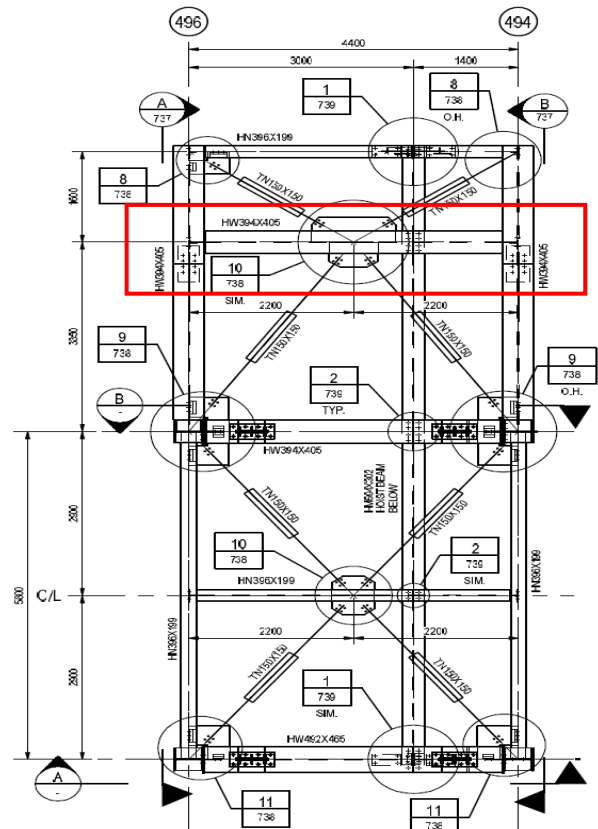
Vista en planta de la viga a reforzar en plataforma de polipasto. Unidades mm
